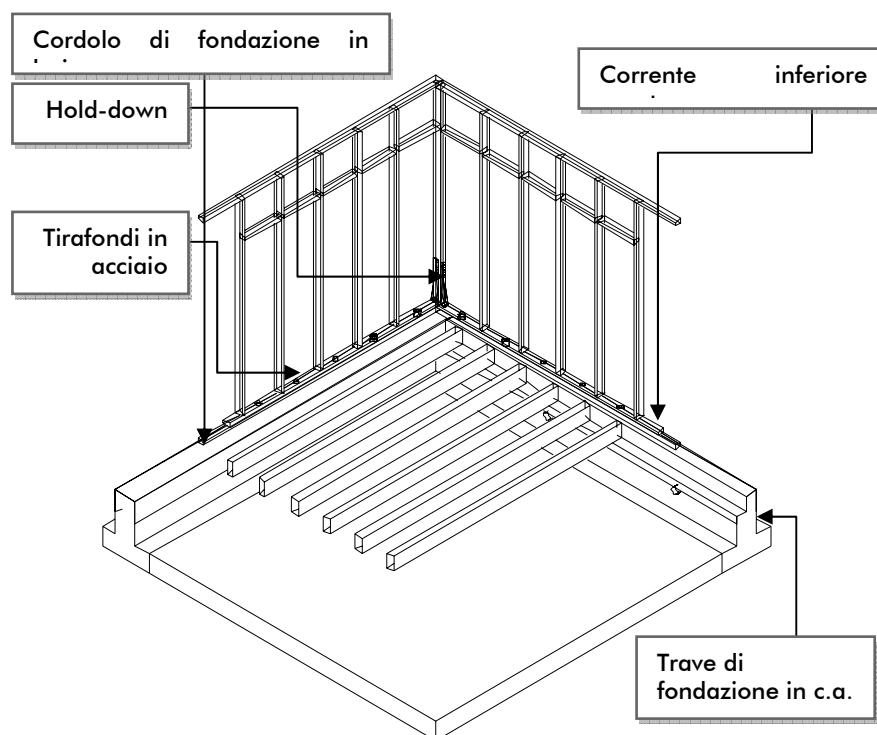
Collegamento alle fondazioni per un edificio Platform Frame.
